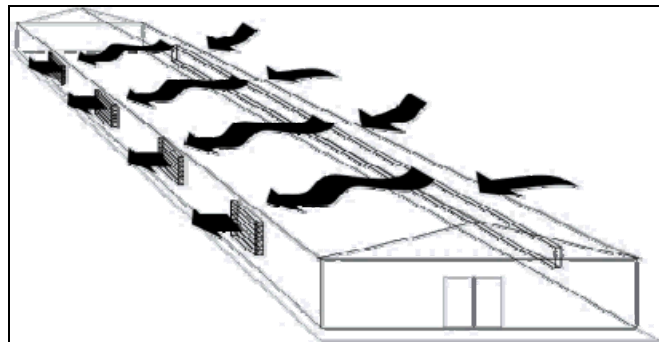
VENTILACIÓN TRANSVERSAL
